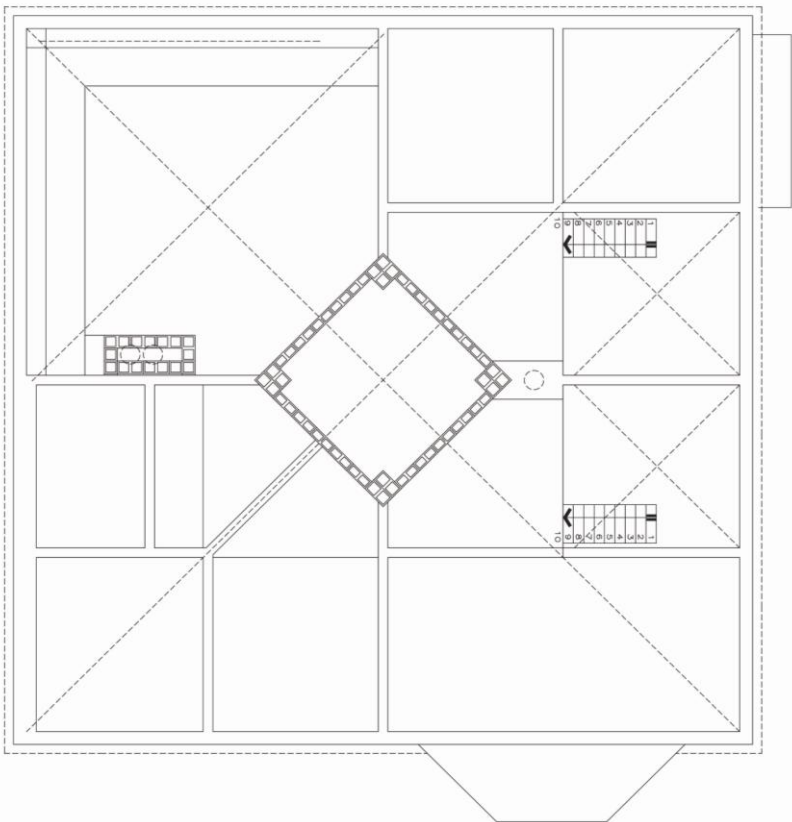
Planta Baixa do mezanino do pavimento superior. Fonte: Defferrari (1999)
